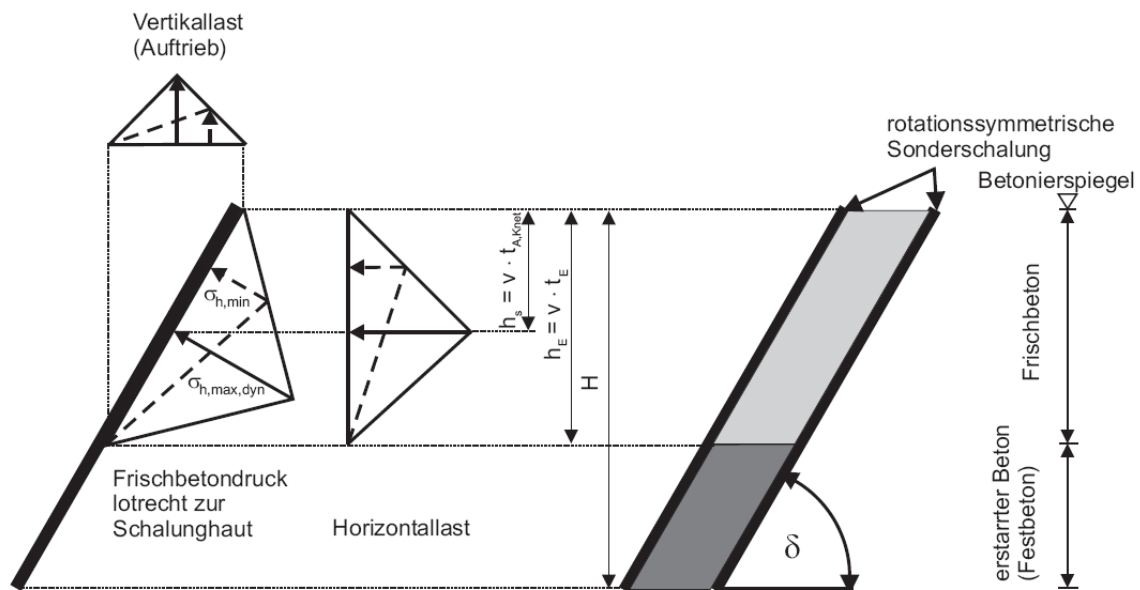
Komponenten des Frischbetondrucks bei einer Deckschalung
